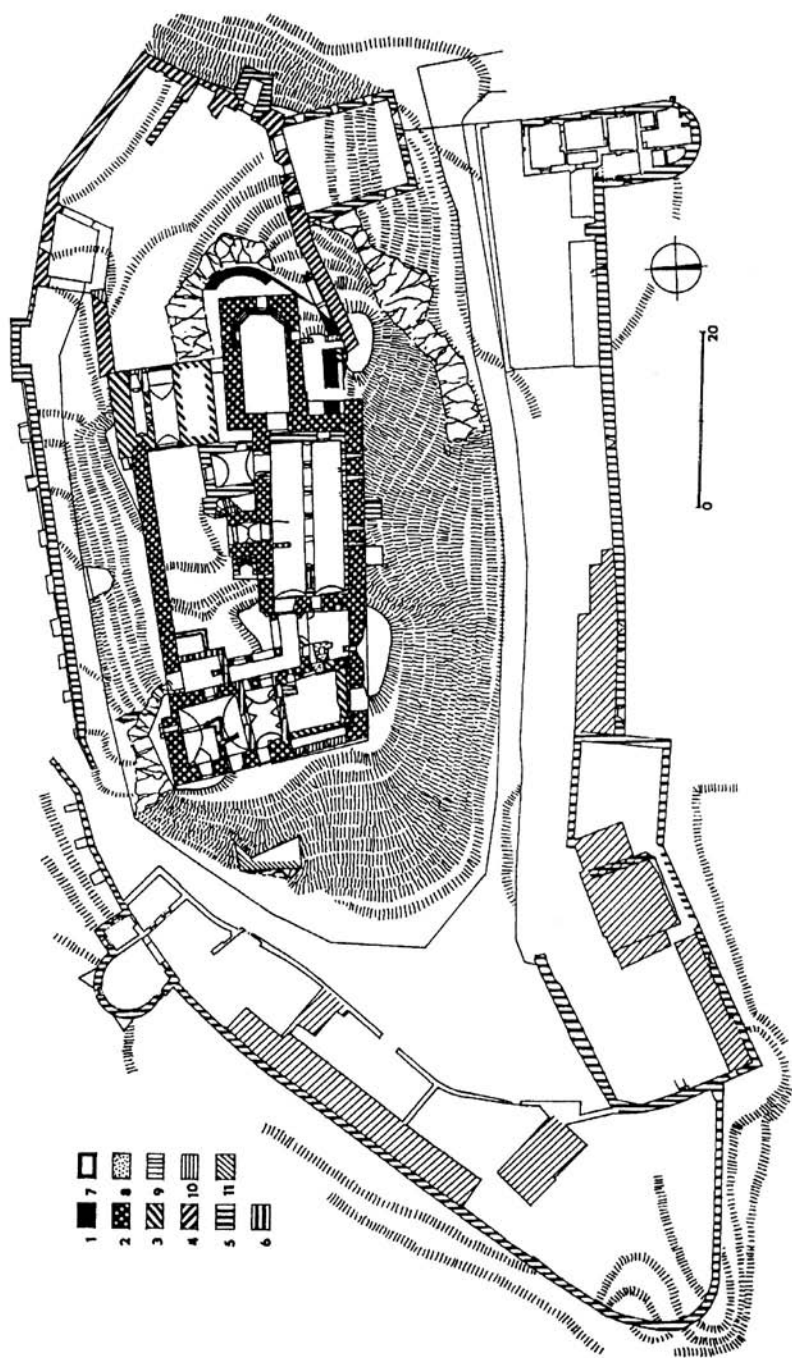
Grundriss der Burg. 1 – Mauerwerk aus dem 13. Jahrhundert, 2 – Mauerwerk der Frána Rokycaners Burg aus der Zeit um die Mitte des 14. Jahrhunderts, 3 – Mauerwerk der zweiten Bauphase aus dem 14. Jahrhundert, 4 – Mauerwerk der dritten Bauphase aus dem 14. Jahrhundert, 5 – Mauerwerk aus der Ende des 15. Jahrhunderts, 6 – renaissancezeitliches Mauerwerk, 7 – jüngeres renaissancezeitliches Mauerwerk, 8 – barockzeitliches Mauerwerk, 9 – neuzeitliches Mauerwerk, 10 – rezentes Mauerwerk, 11 – nicht datiertes Mauerwerk. Zeichnung: V. Durdik.
